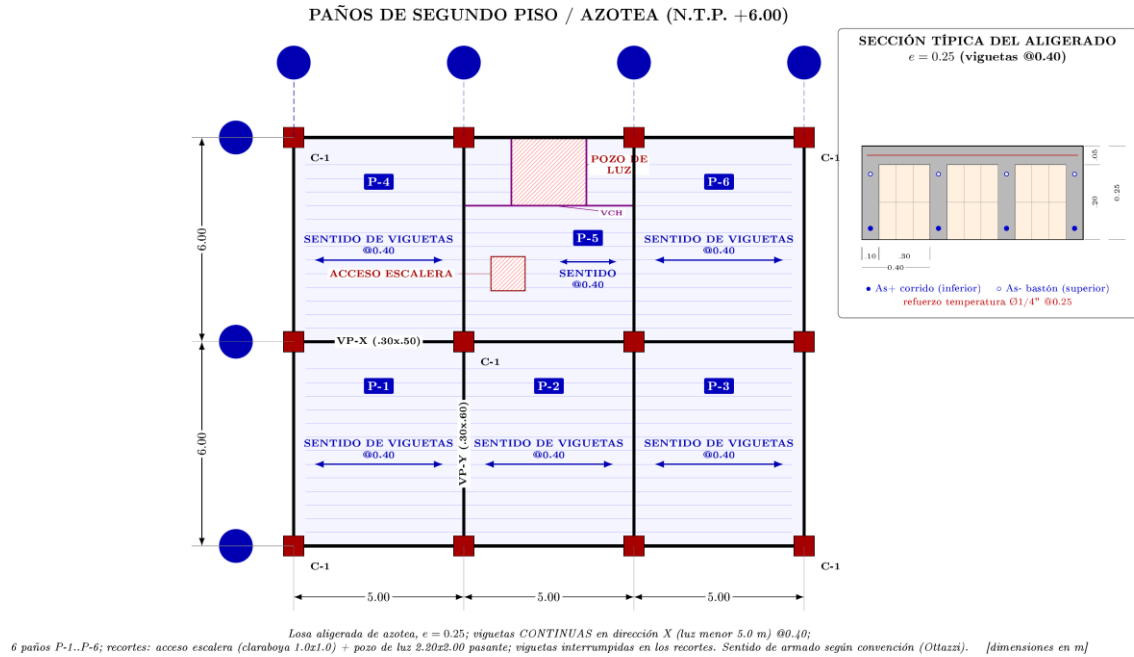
Distribución de paños de losa aligerada, segundo piso.
